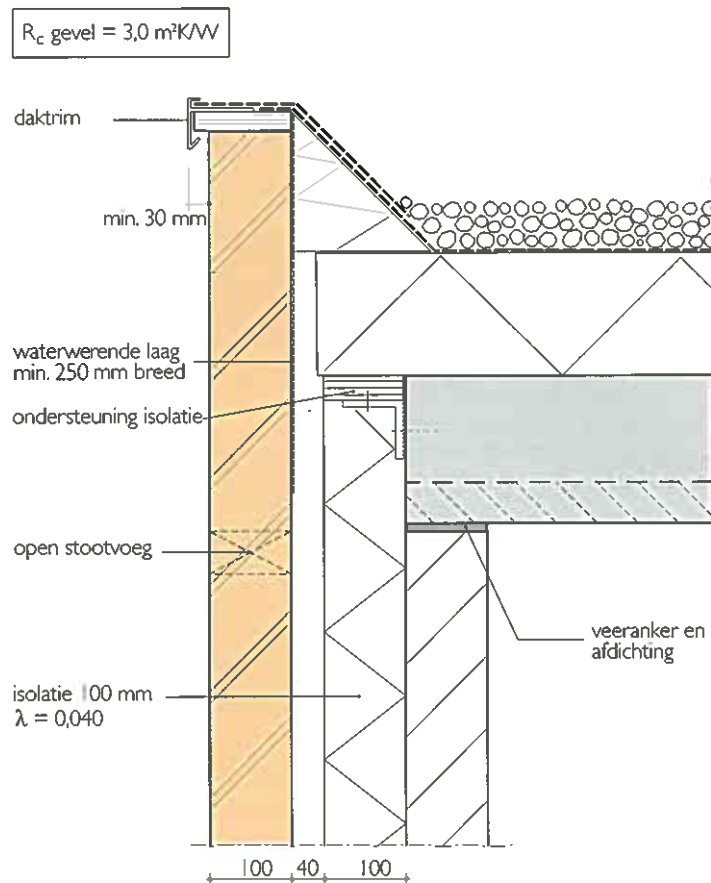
Detailtering VAN BAKSTEEN-CONSTRUCTIES
